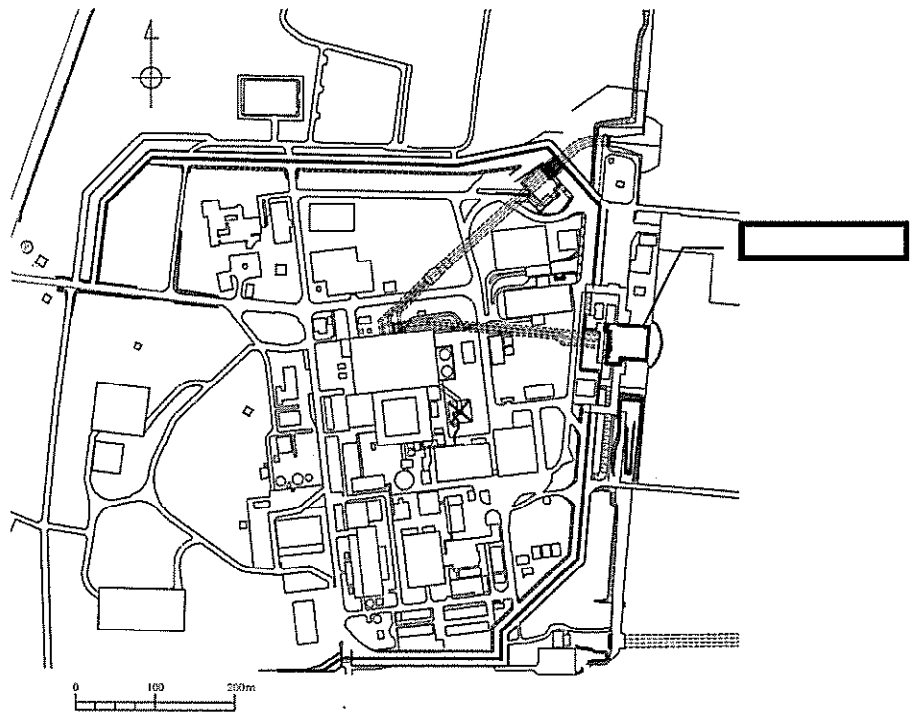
(1) 取水構造物の平面配置図（全体平面図）
